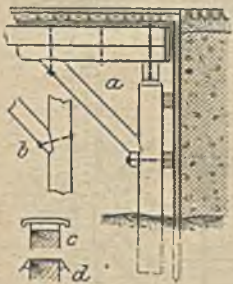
Holzernes Endwiderlager einer Straßenbrücke.
